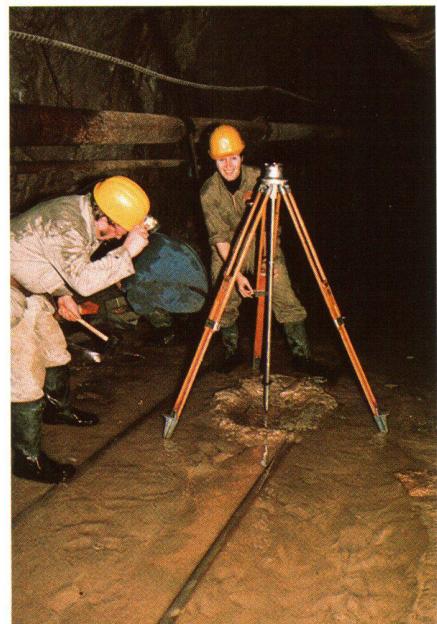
Assurance des points fixés. Une plaque de laiton ancrée dans la roche au fond du tunnel est dégagée.
